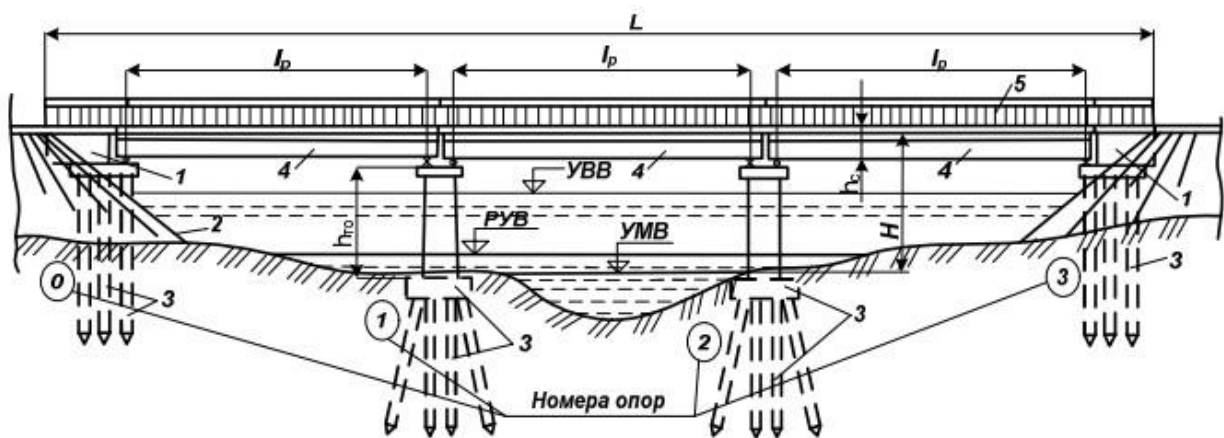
Міст загальною довжиною L : 1 – берегові опори (стовпи) на пальових фундаментах; 2 – конус насипу; 3 – пальовий фундамент; 4 – прогонна надбудова із суцільними головними балками; 5 – перильні обгородження; УВВ – рівень висоти води; РУВ – робочий рівень води; УМВ – межевий рівень води
